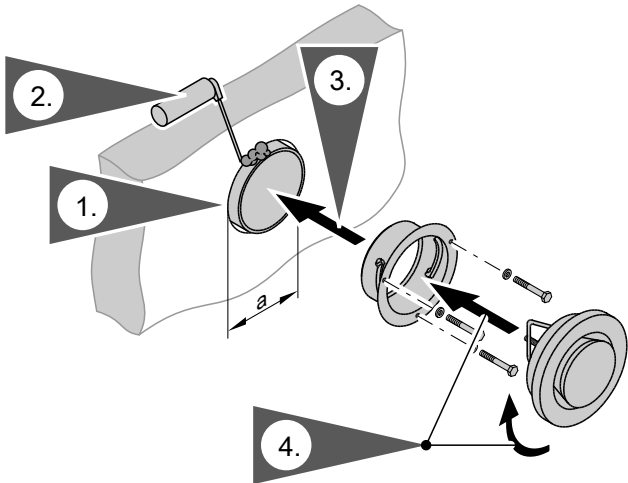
Пример: настенный монтаж клапана уходящего воздуха
